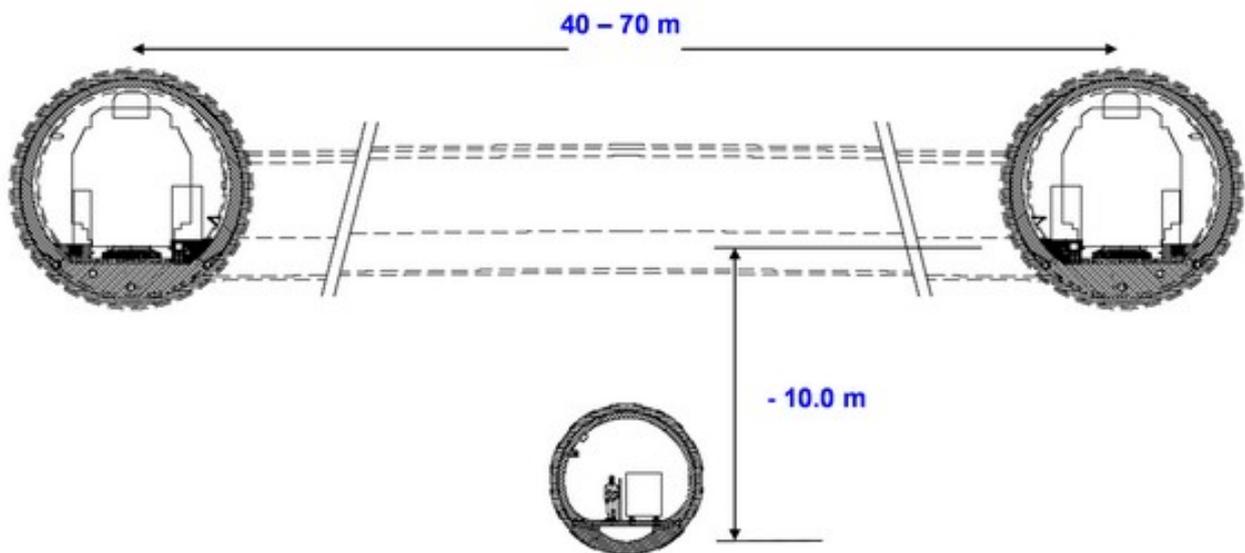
Das Tunnelsystem des Brenner Basistunnels in der Betriebskonfiguration
